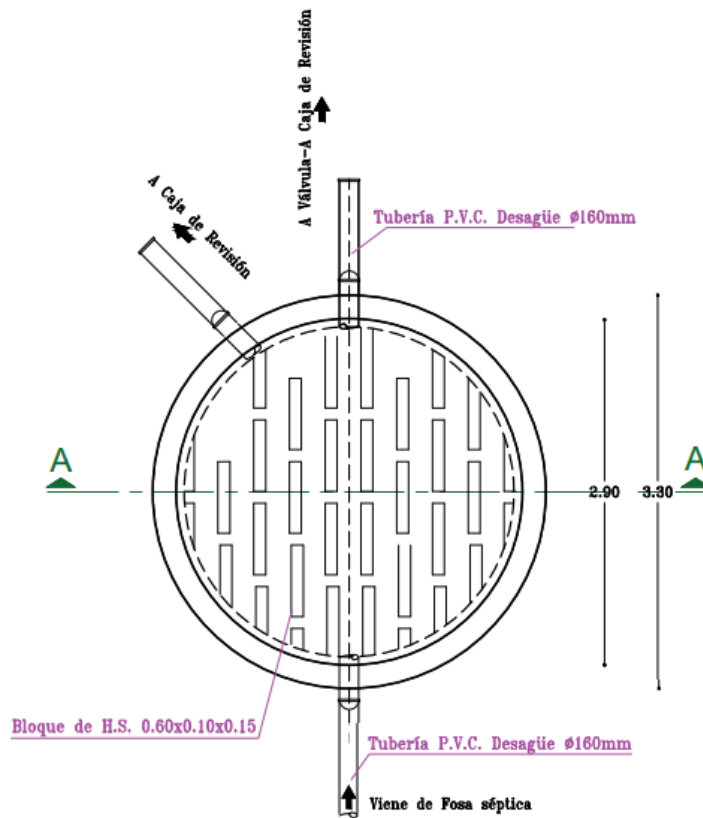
Vista en planta del FAFA 1 y 2 de la PTAR.
